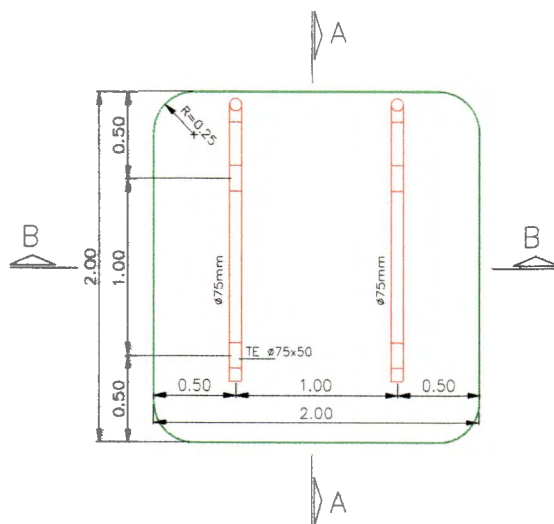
Planta Baixa do reator UASB (cotas em metros)
